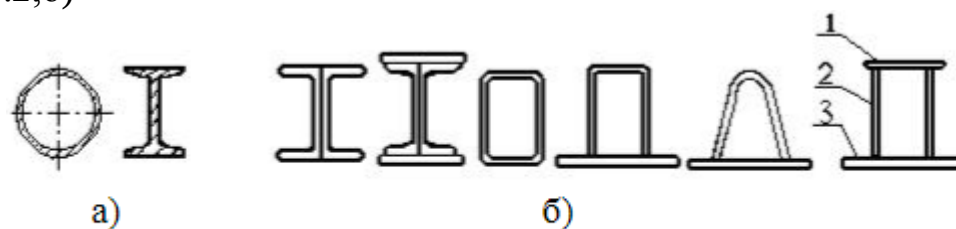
Примеры конструкций балок. 1-верхний пояс;
